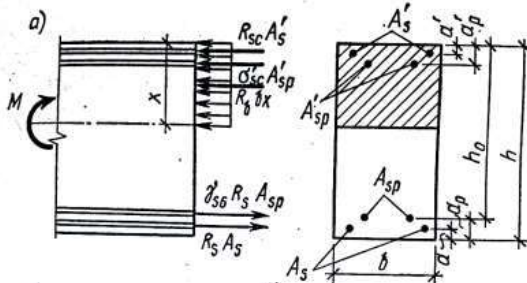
Схема усилий и эпюра напряжений в нормальном сечении изгибаемого предварительно напряженного элемента армированного растянутой и сжатой напрягаемой арматурой
